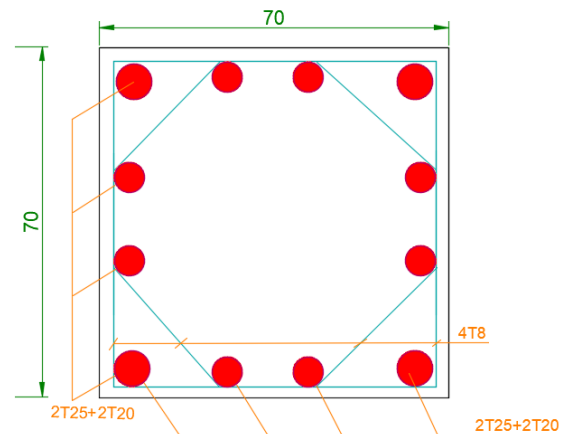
Schéma De Ferrailage Des Poteaux de 1^{er} et 2^{eme} étages.
